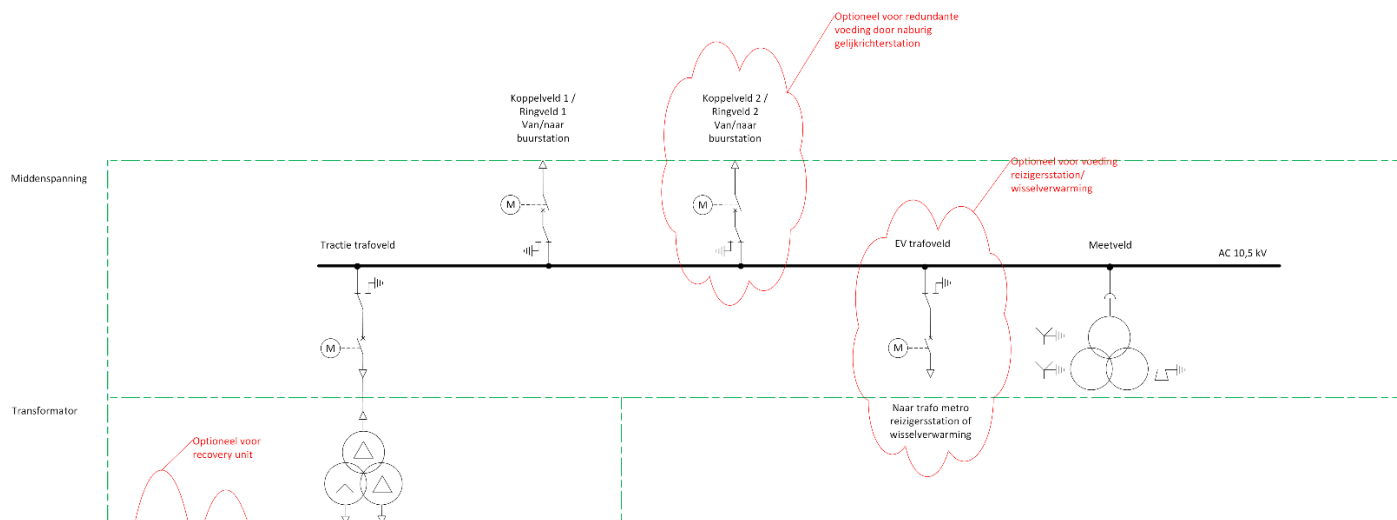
Typical GS met inkoopverdeler Tram en Metro, op 10kV niveau
